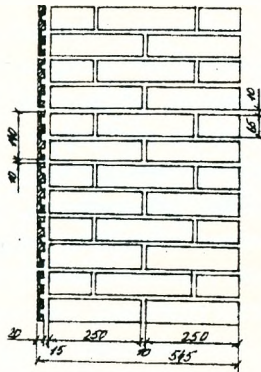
а. Облицовка кирпичной кладки керамическими плитами высотой 65 мм.
